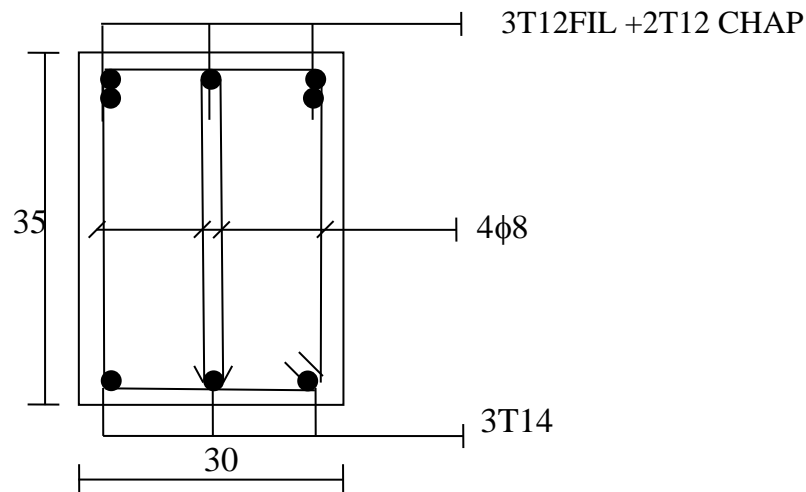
Schéma de ferrailage de la poutre secondaire (en appui)
